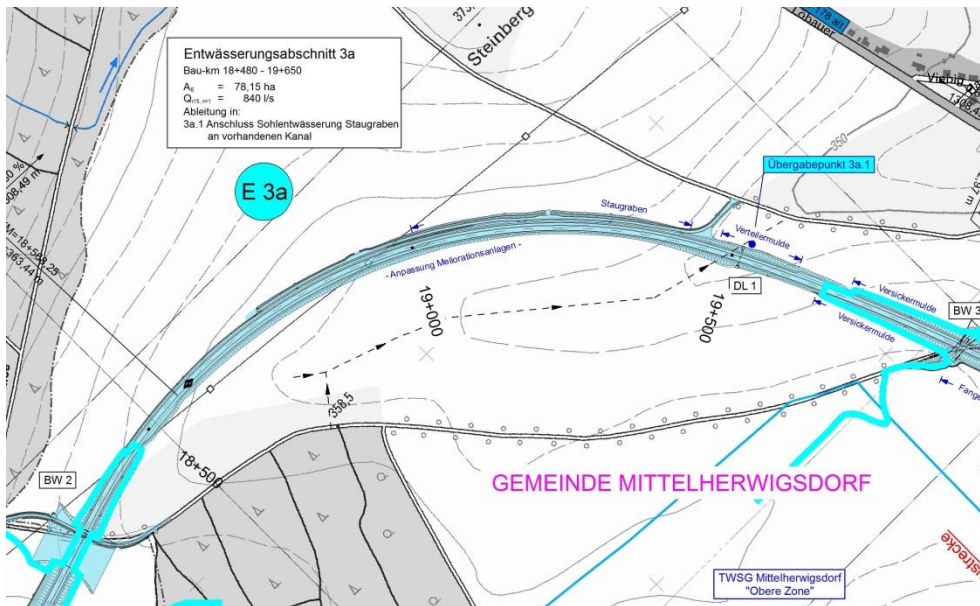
Entwässerungsabschnitt 3a: Ableitung in vorhandenen Kanal (IB LANGENBACH 2016)
